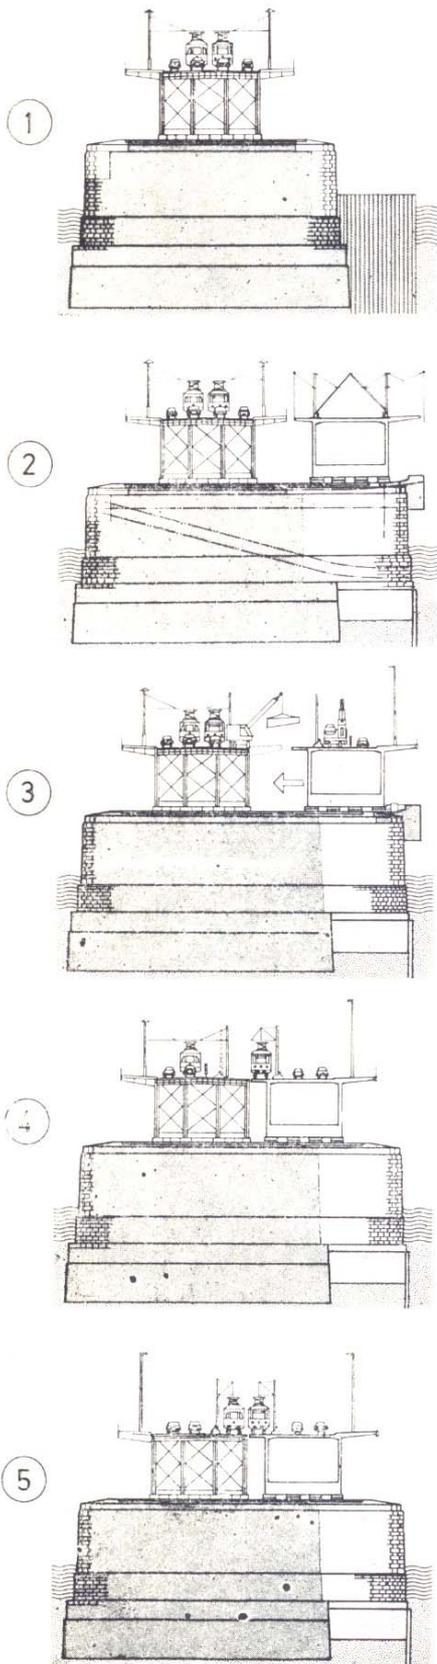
Puente Köln-Deutz - Fases de construcción - Explicaciones en el texto.
